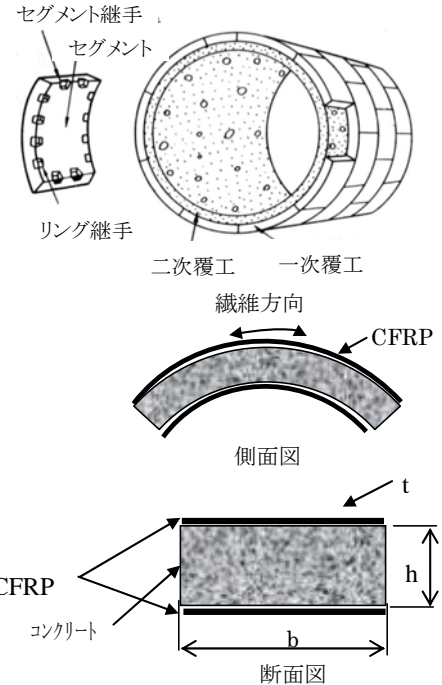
従来の RC セグメント(上)と CFRP・コンクリート合成セグメント(下)の概要図
